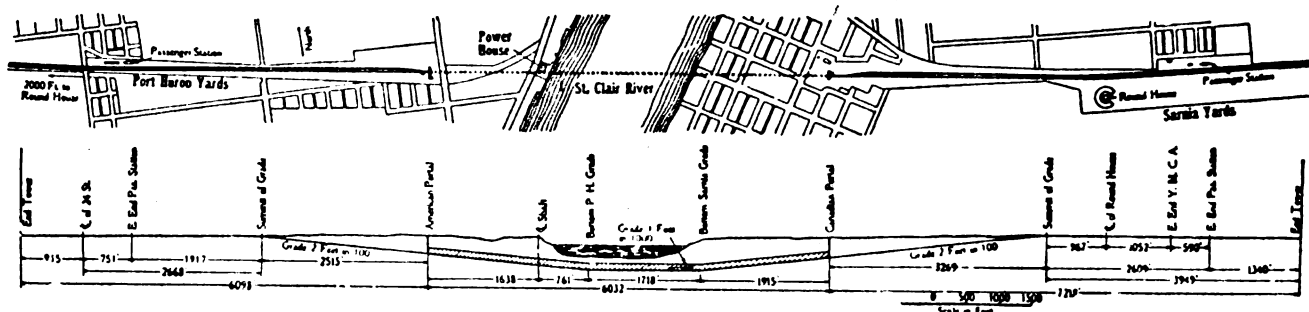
Piano e Sezione del St. Clair Tunnel.
